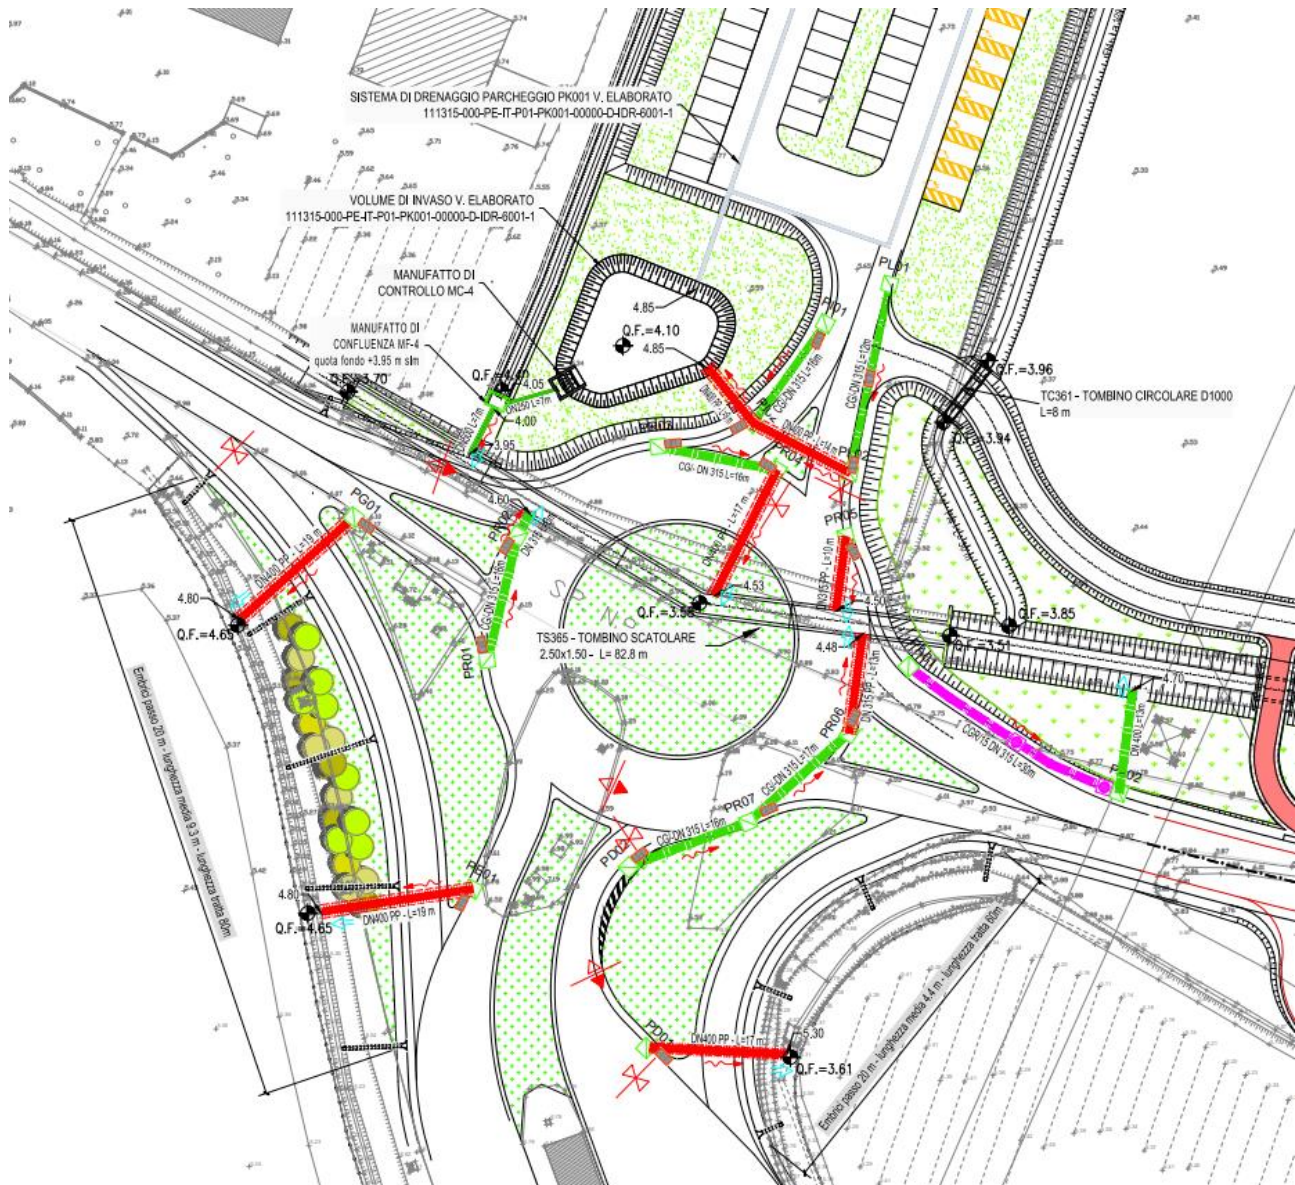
Planimetria della rete di drenaggio della rotonda RO001
